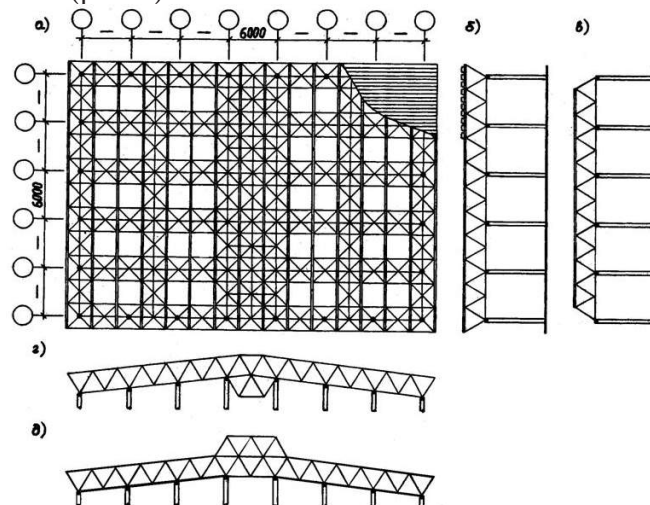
Схемы большепролетного пространственно-стержневого покрытия: а – план (общий вид); б – консольное опирание; в – бесконсольное опирание; г – подстропильно-бесфонарная конструкция; д – подстропильно-фонарная конструкция
